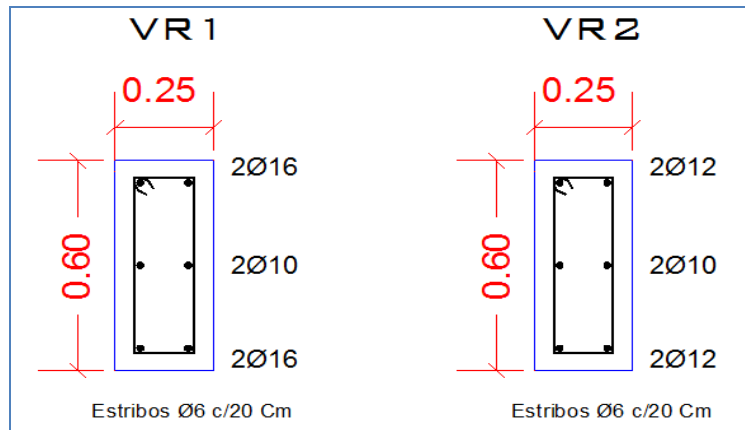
Corte transversal de las riostras VR1 y VR2 .
